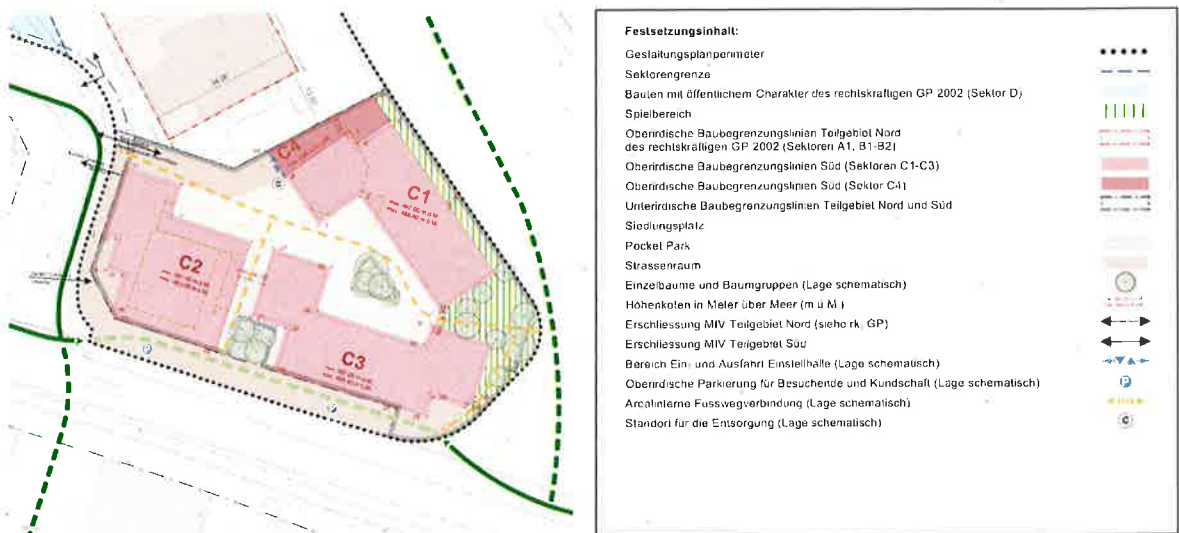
Planausschnitt Revision öffentlicher Gestaltungsplan Gwärfihölzli
